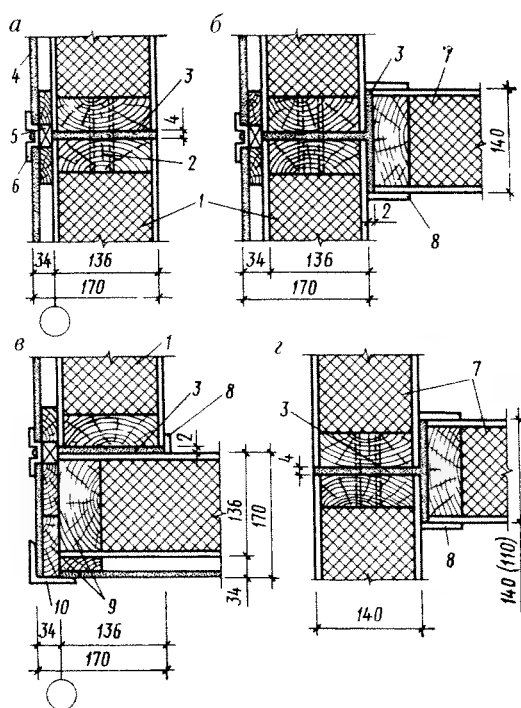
Конструкция вертикальных швов в клефанерных панелях наружных и внутренних стен:
